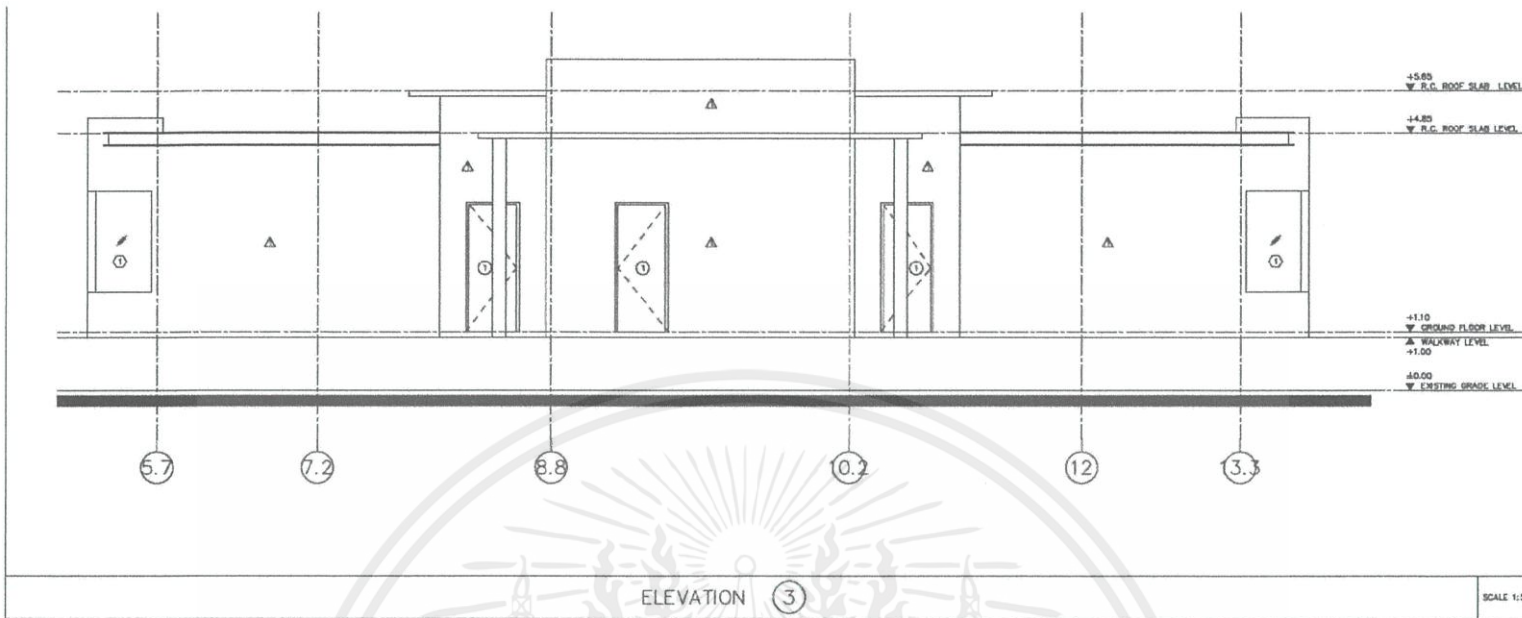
Elevation1 restaurant (All day dining restaurant & bar)
